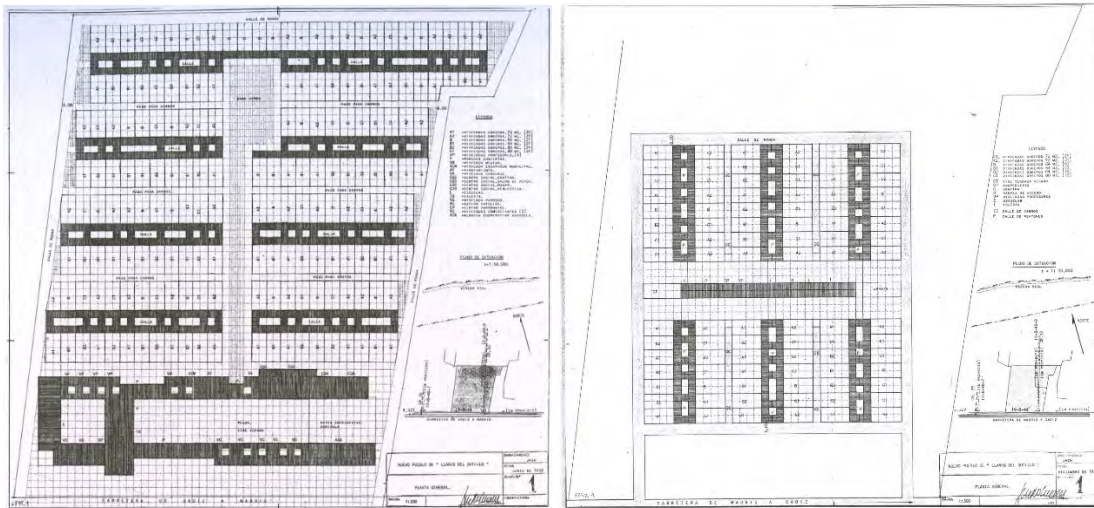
Versión primera y segunda, planta general, Formas de arquitectura y arte 16.
